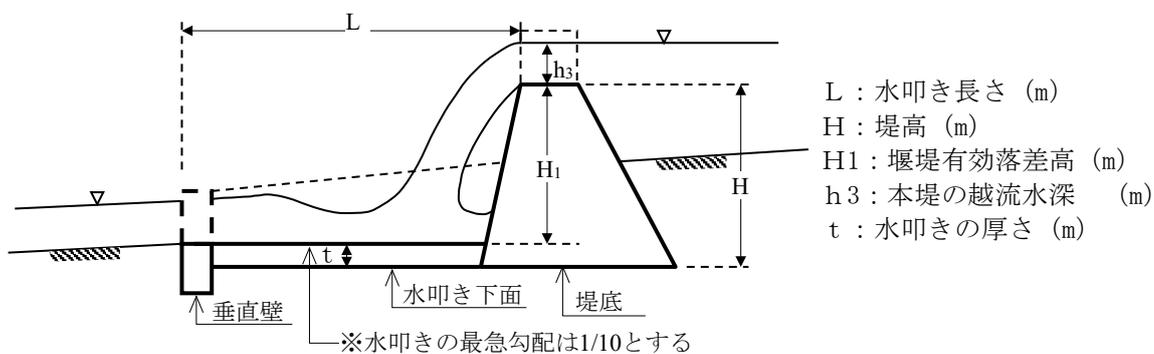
水叩き長さおよび水叩き厚さ（経験式の場合）
